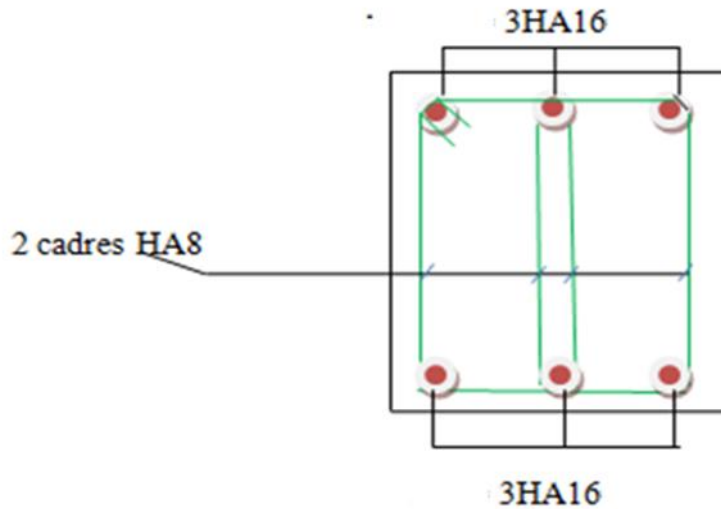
Coupe vertical en travée des poutres secondaires
